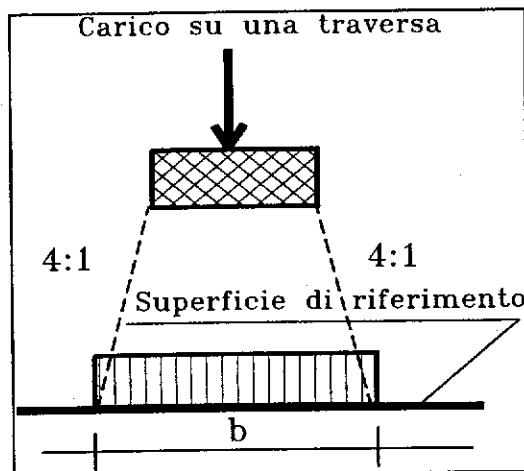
Distribuzione longitudinale dei carichi attraverso il ballast.
